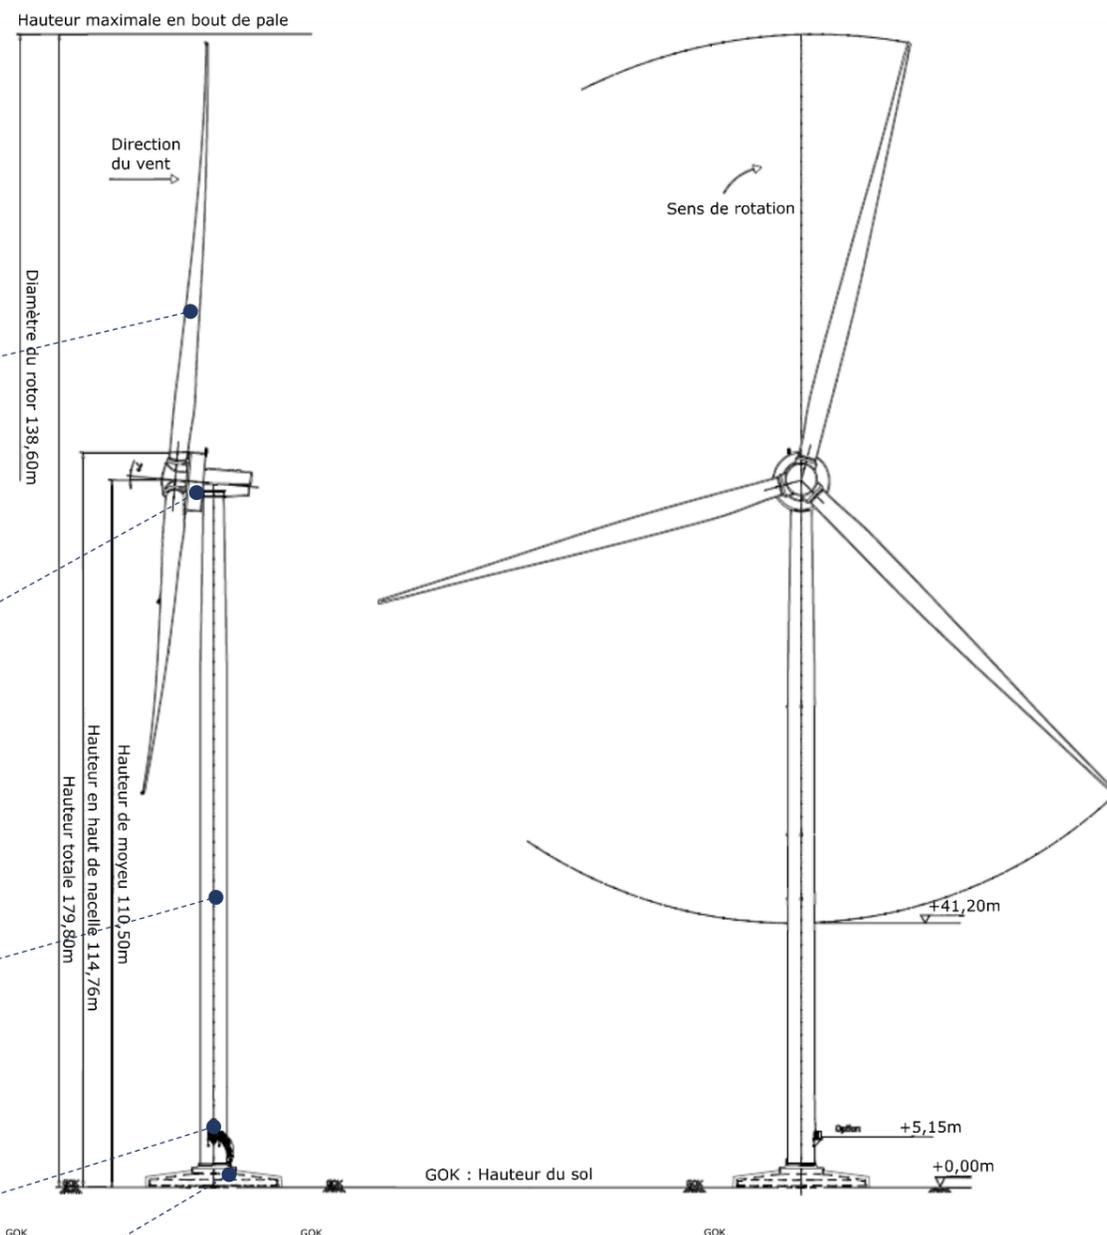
Plan d'élévation de l'éolienne E-138-EP3 - 180m bout de pale (Source : ENERCON)
